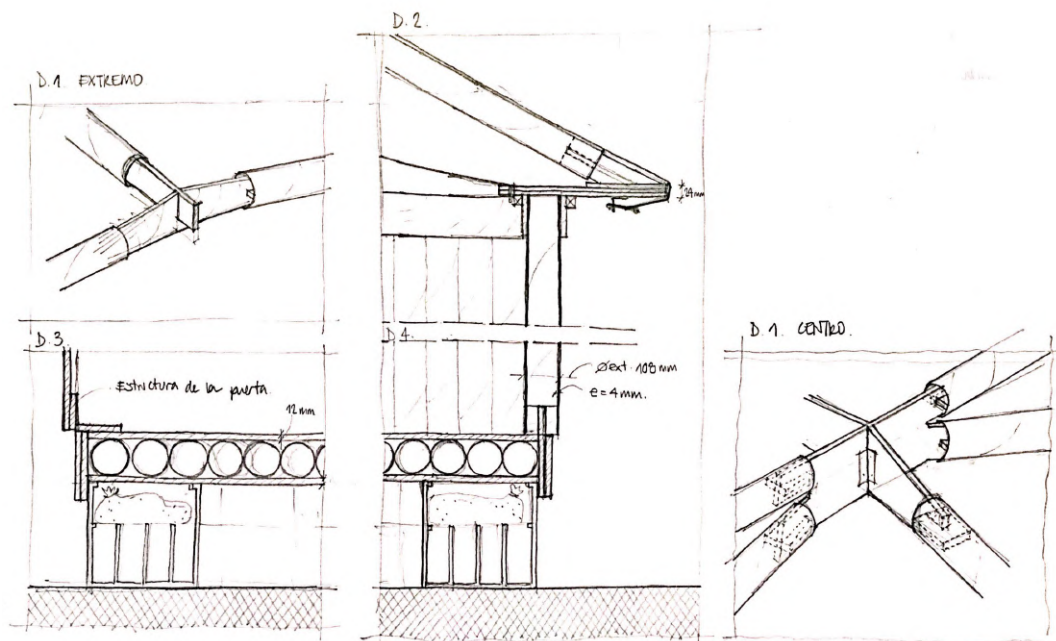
Detalles constructivos de los puntos de encuentro de elementos estructurales.
